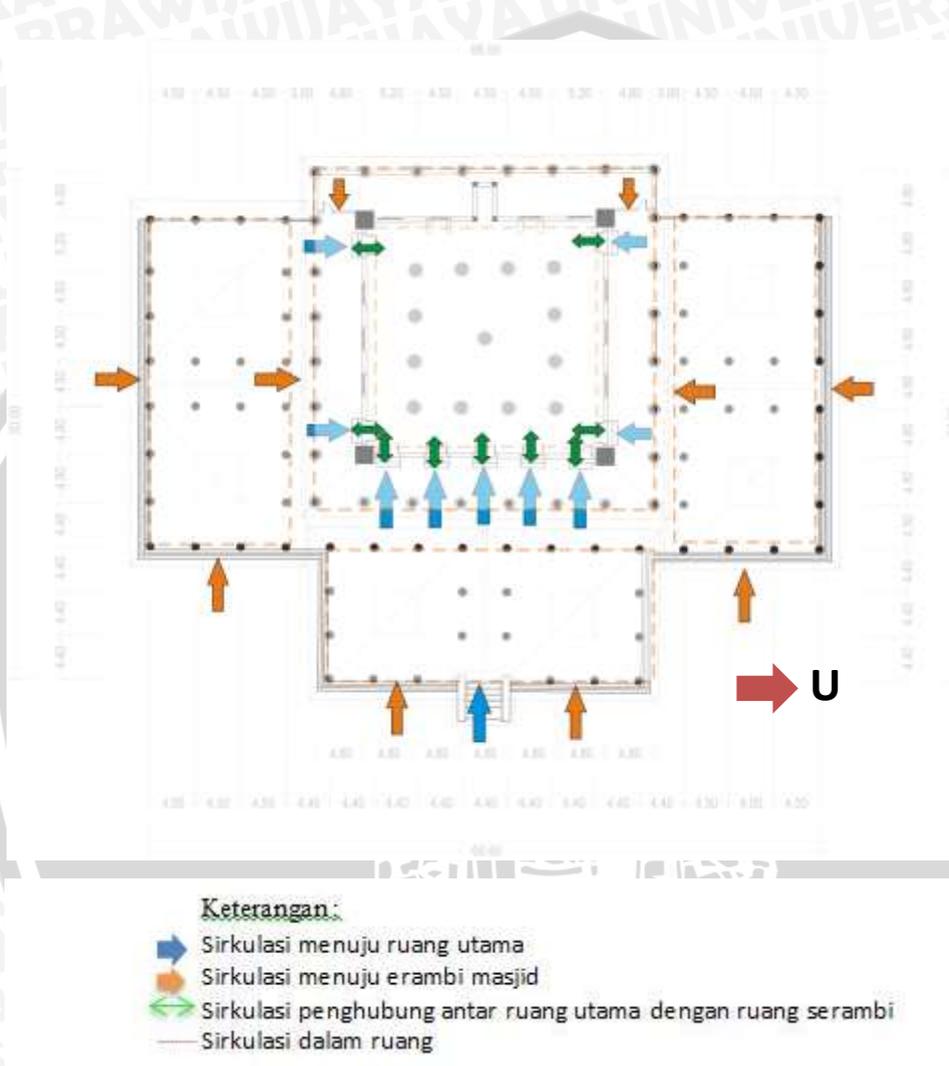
Pola ruang dalam bangunan setelah ada bangunan tambahan
